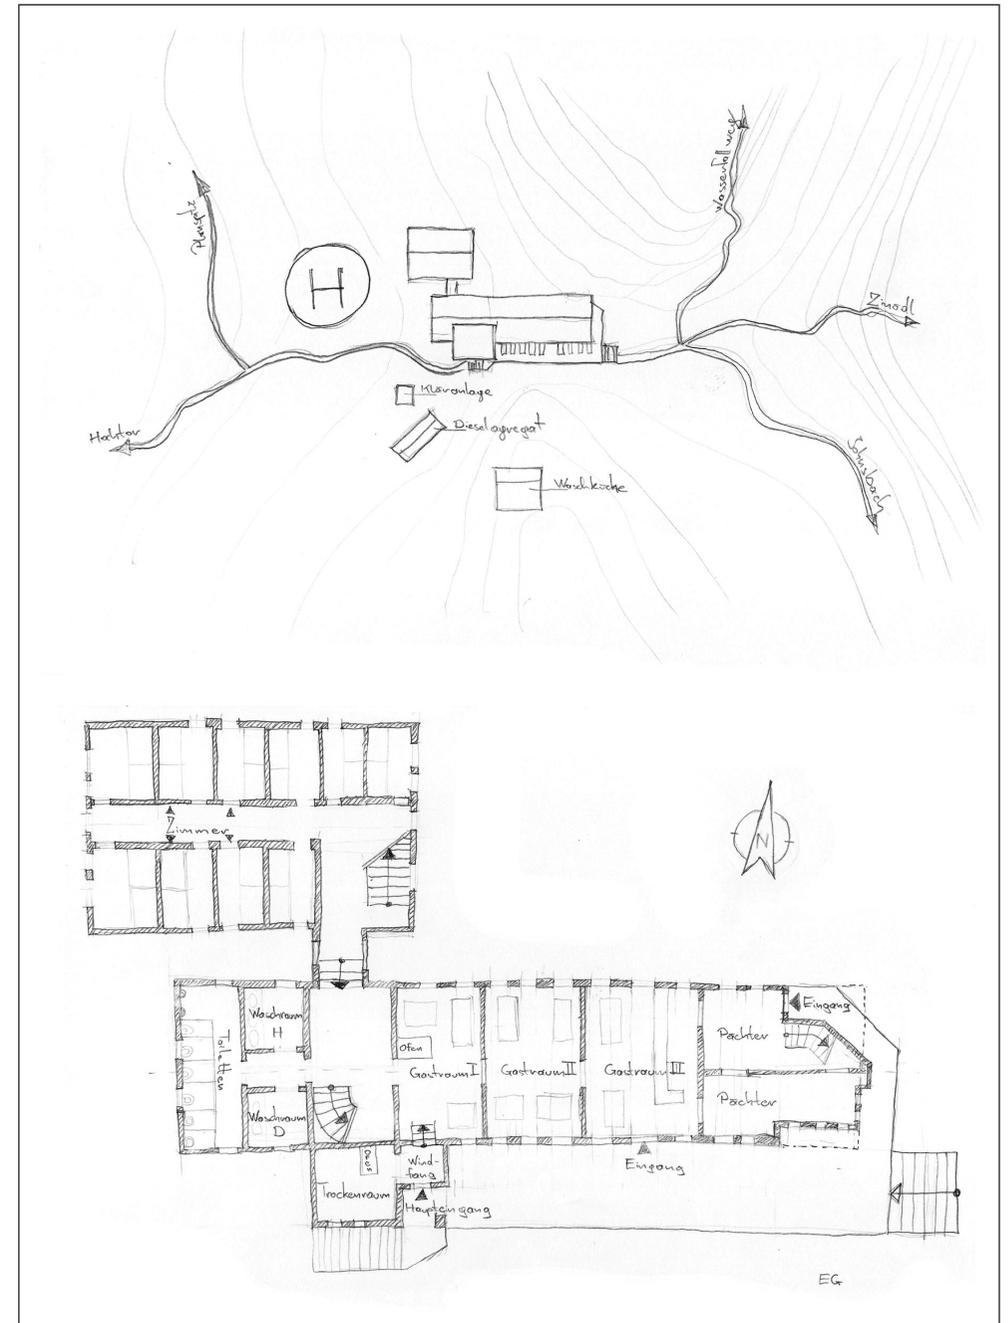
links: Skizze Lageplan und Grundriss Erdgeschoß
